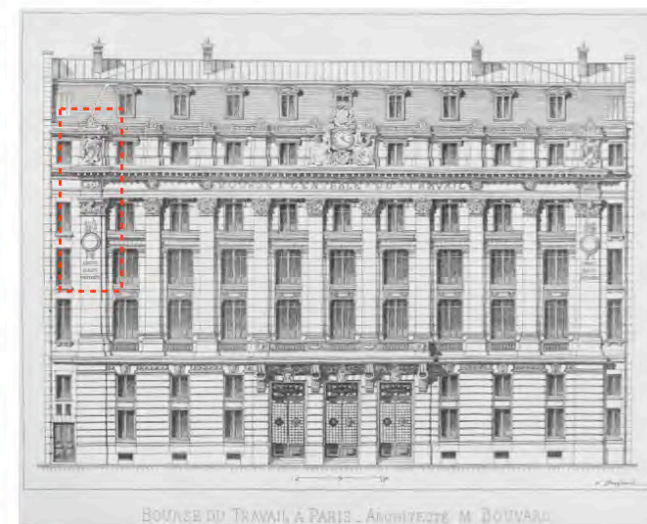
La Bourse du Travail. Fachada e detalhe da ornamentação. (Fonte: La Construction Moderne, CM-1890-08-LA BOURSE DU TRAVAIL, 1890)
